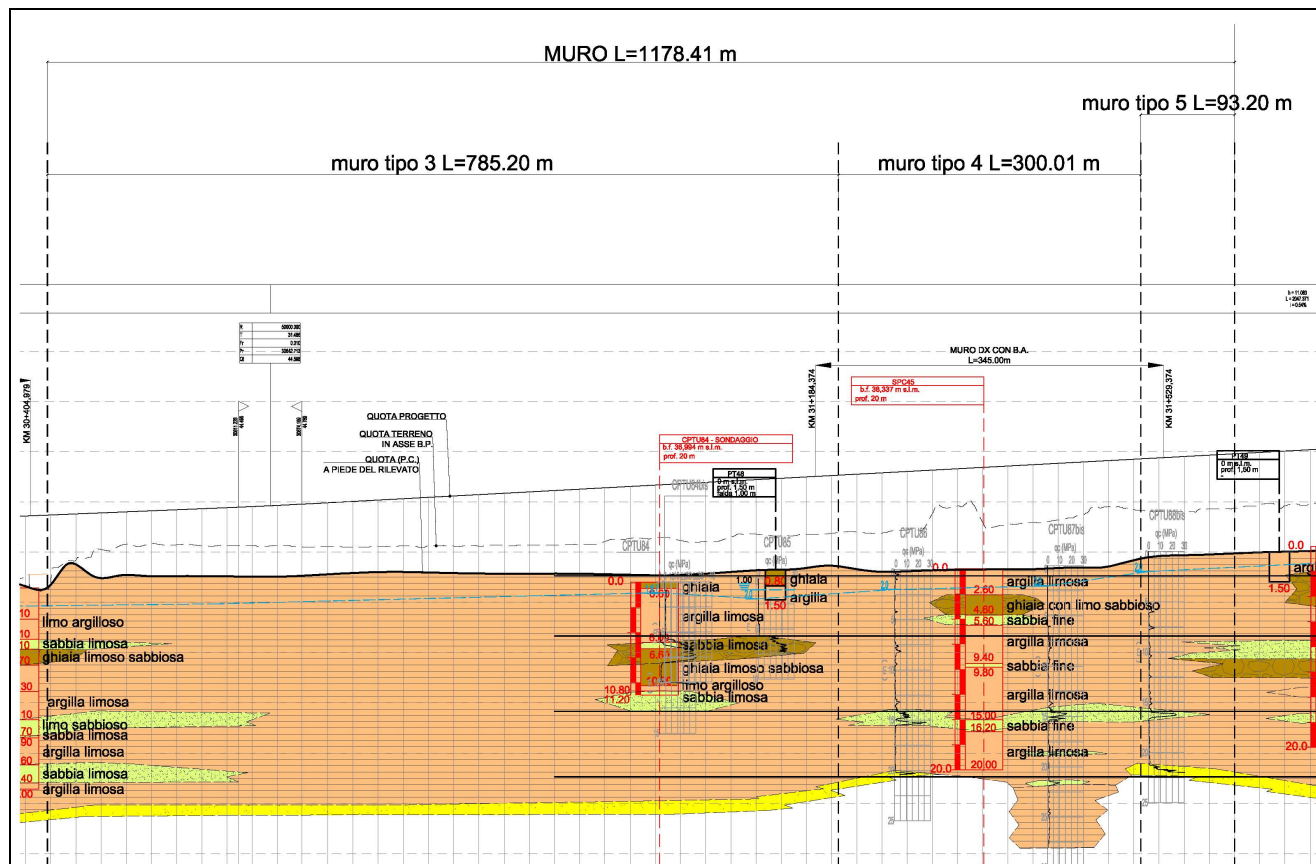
profilo geotecnico di progetto nel tratto interessato dalla costruzione del muro
